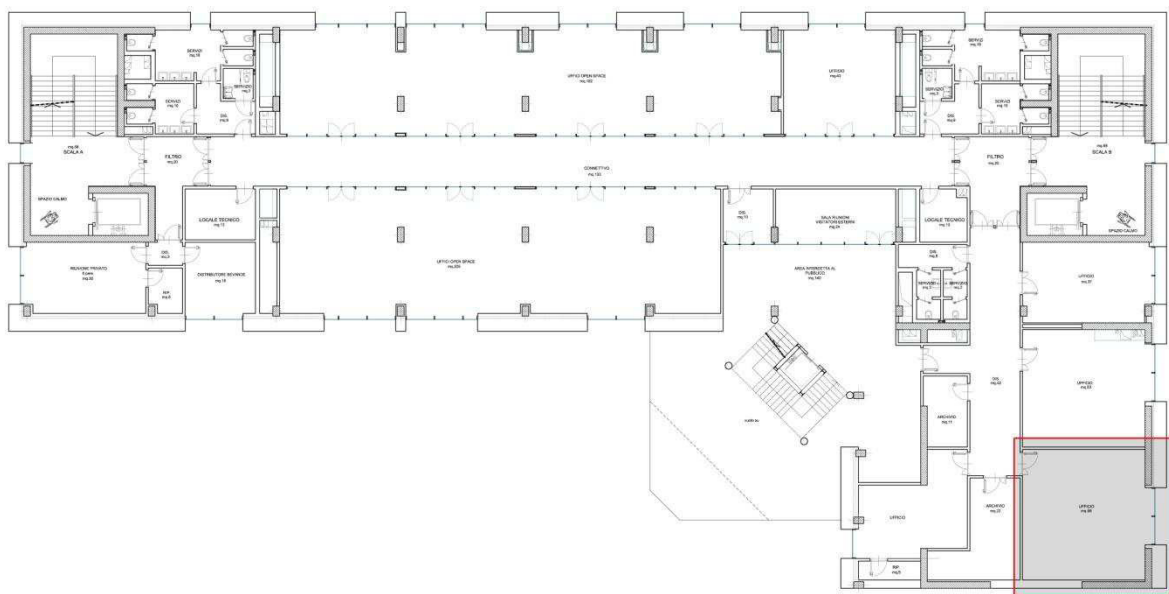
Pianta primo piano con individuazione del solaio analizzato.
